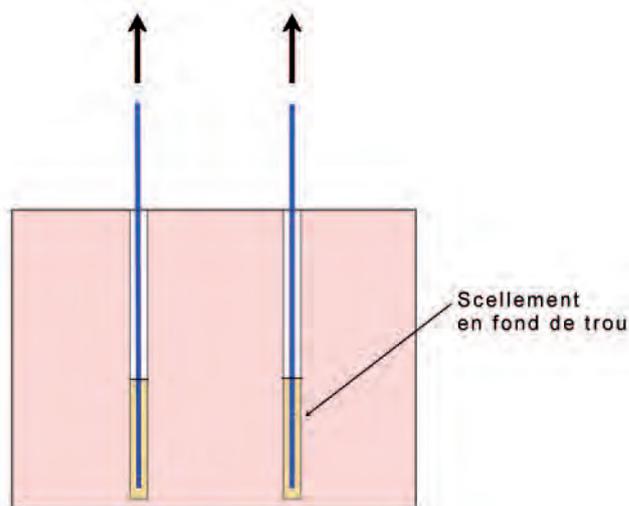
dispositif de suspension d'une pièce en béton non armé, en pierre...
